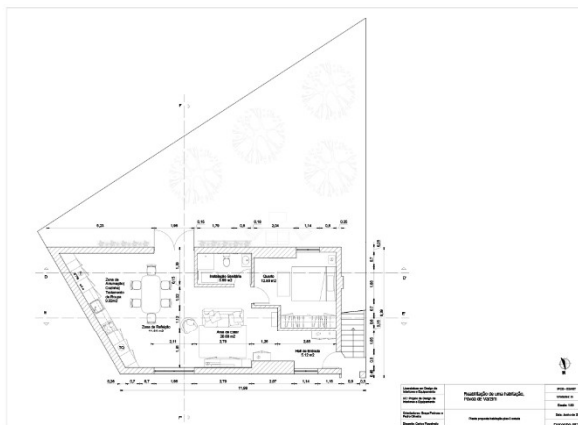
Planta Cotada Habitação Piso 0. Fonte: Autor.
